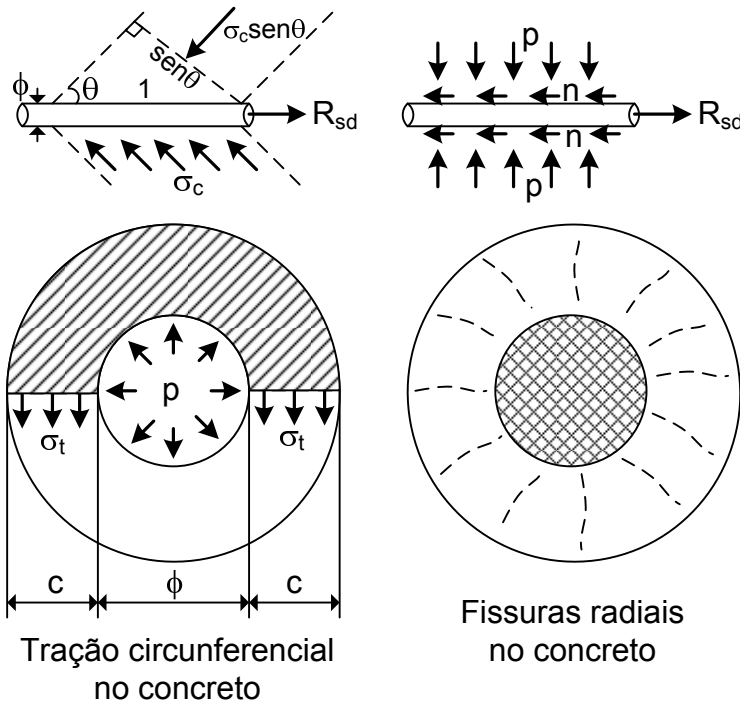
Bielas de compressão ancorando a barra de aço e fissuração do concreto na região da ancoragem
